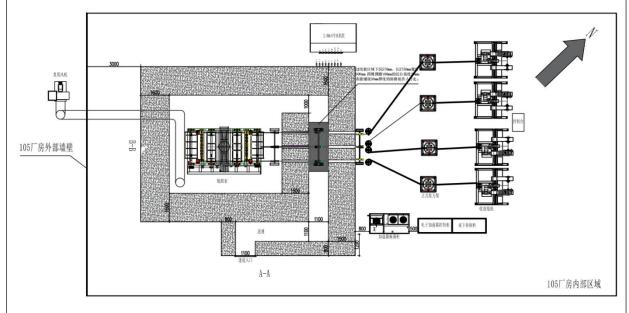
本项目一层辐照室及配套区域平面布置图
